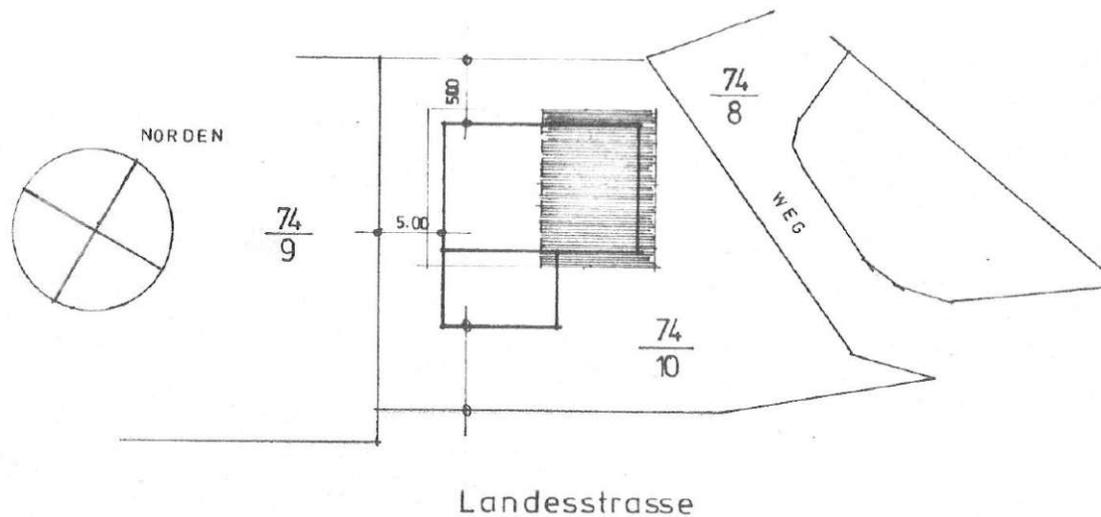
Lageplan des Bestandsgebäudes [47]
